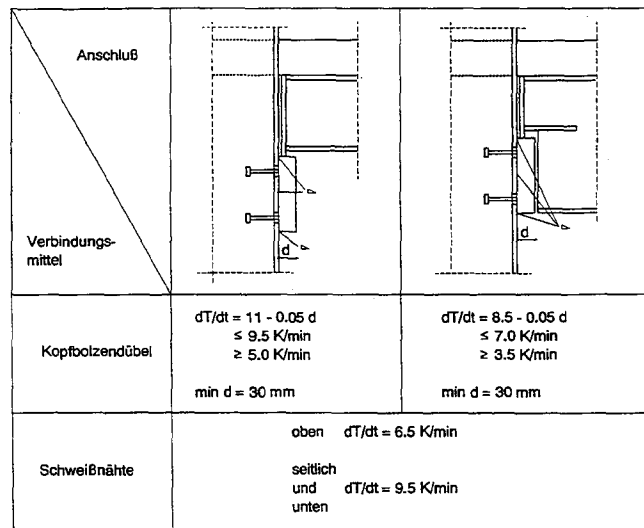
Aufheizgeschwindigkeit von Schweißnähten und Kopfbolzendübeln bei Knaggenanschlüssen
